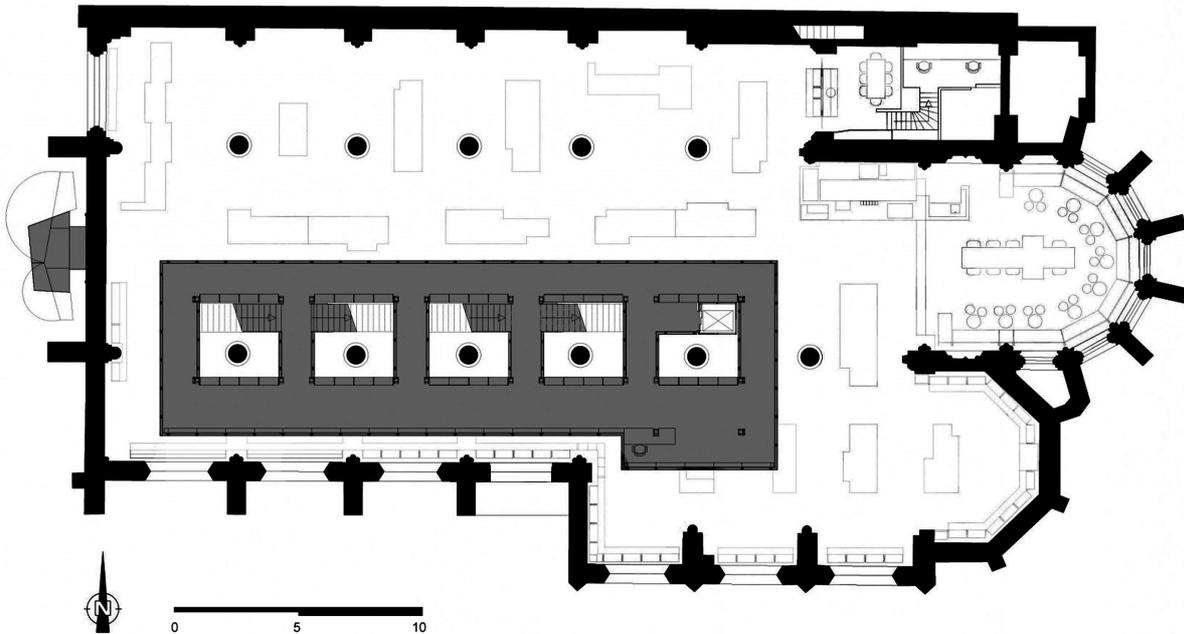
Grundriss Dominikanerkirche
